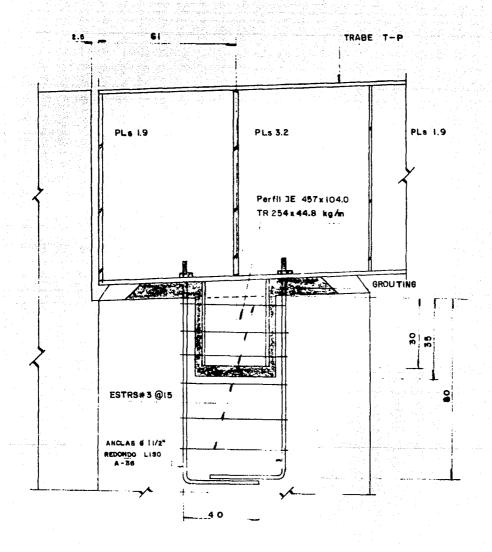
ANCLAJE DEL MURO TAPON A LA ESTRUCTURA METALICA.
